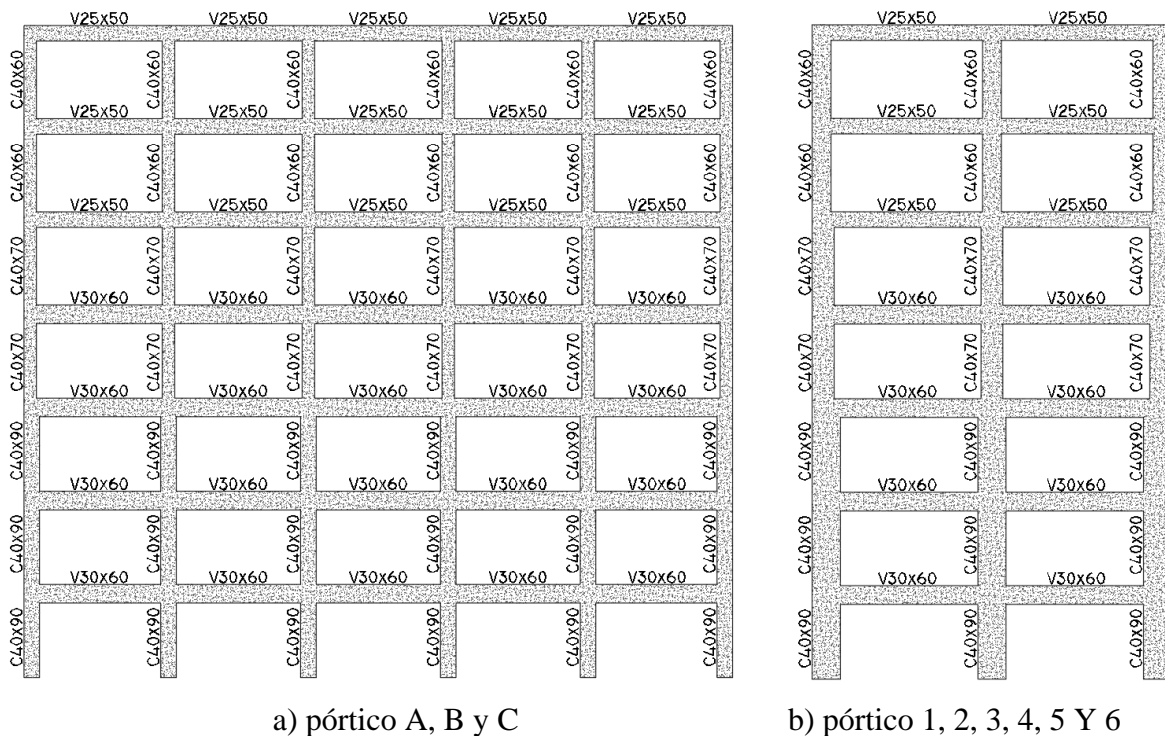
Columnas y Vigas en Elevación, Estructura Esencial [7N-EE].
